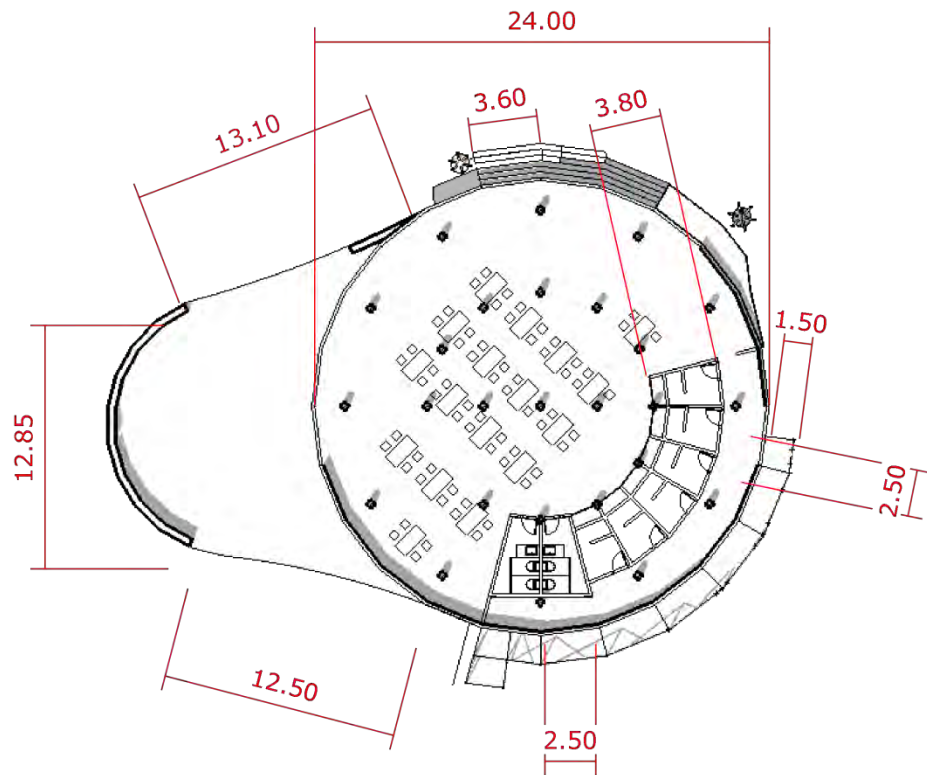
Denah Lantai 2 Bangunan Utama
